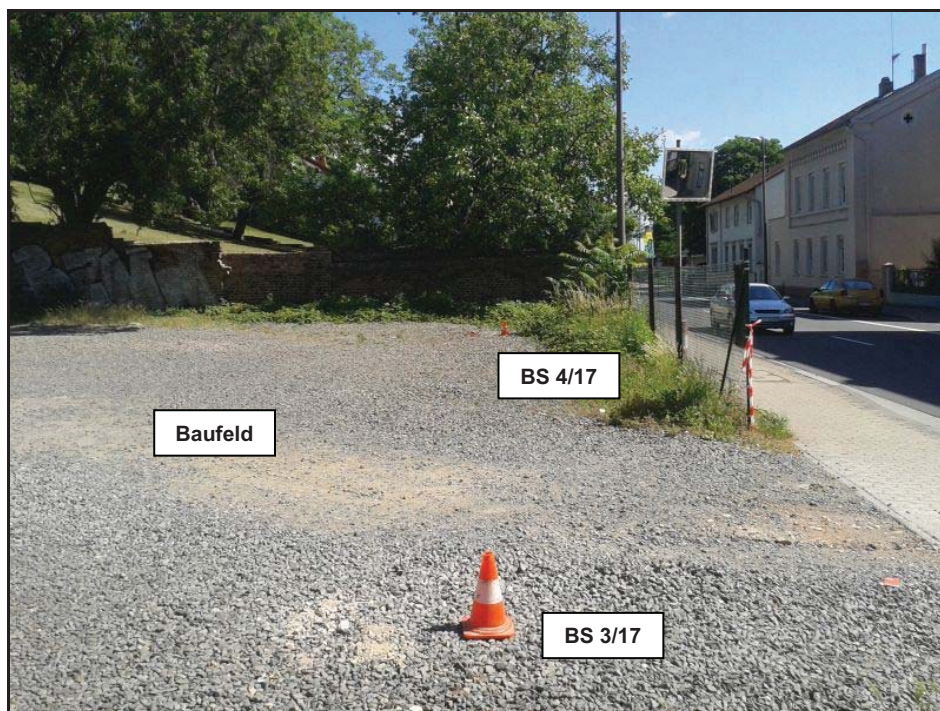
Blickrichtung nach NE auf das Baufeld; Stand: 10.06.-12.06.2017
